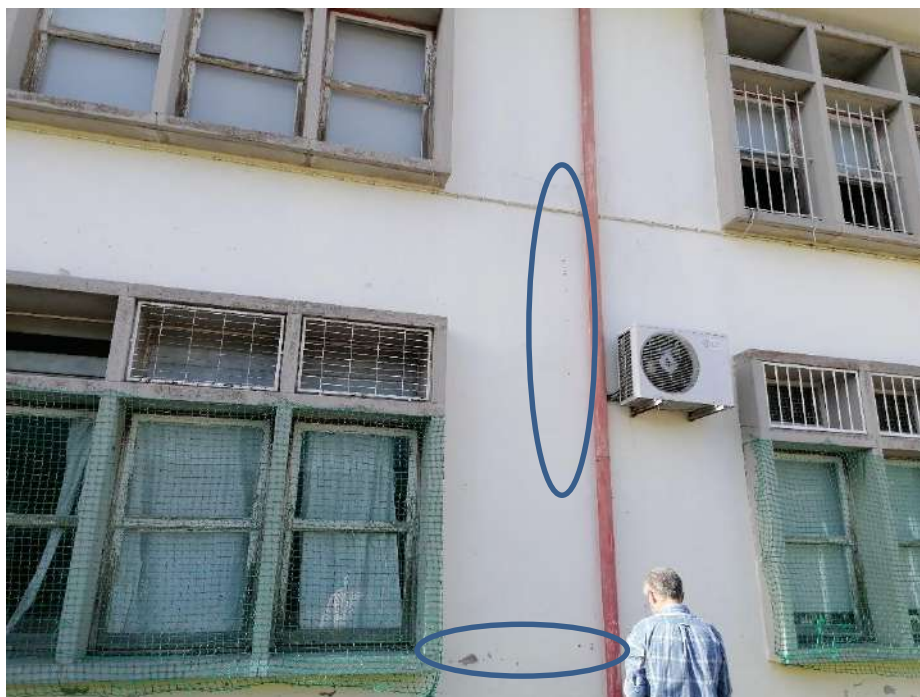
Furação na fachada da EB23 Almirante Gago Coutinho para definição das dimensões dos elementos estruturais do pórtico de betão armado (na ausência de dados de projeto)
